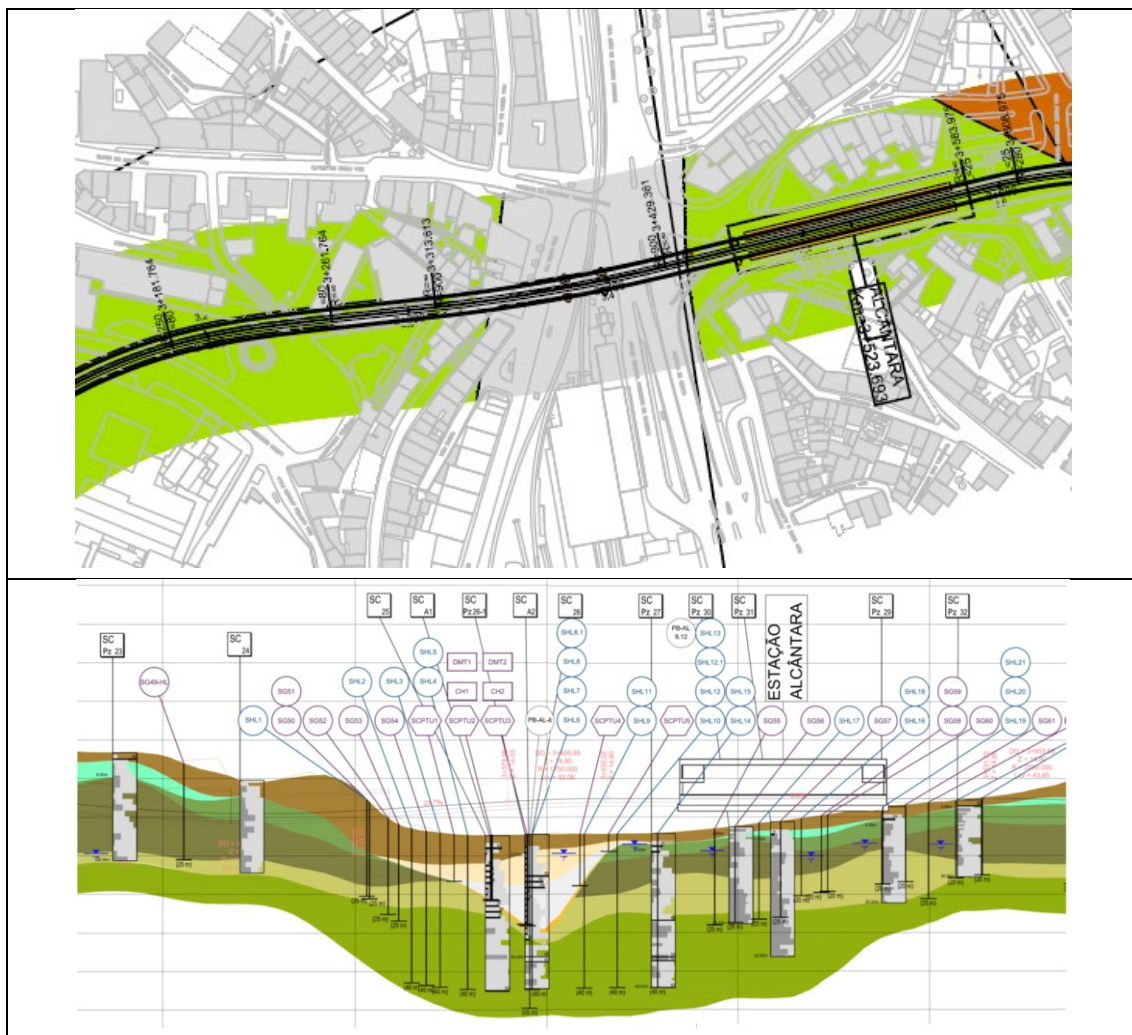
Planta e perfil longitudinal – Geologia / Geotecnia
